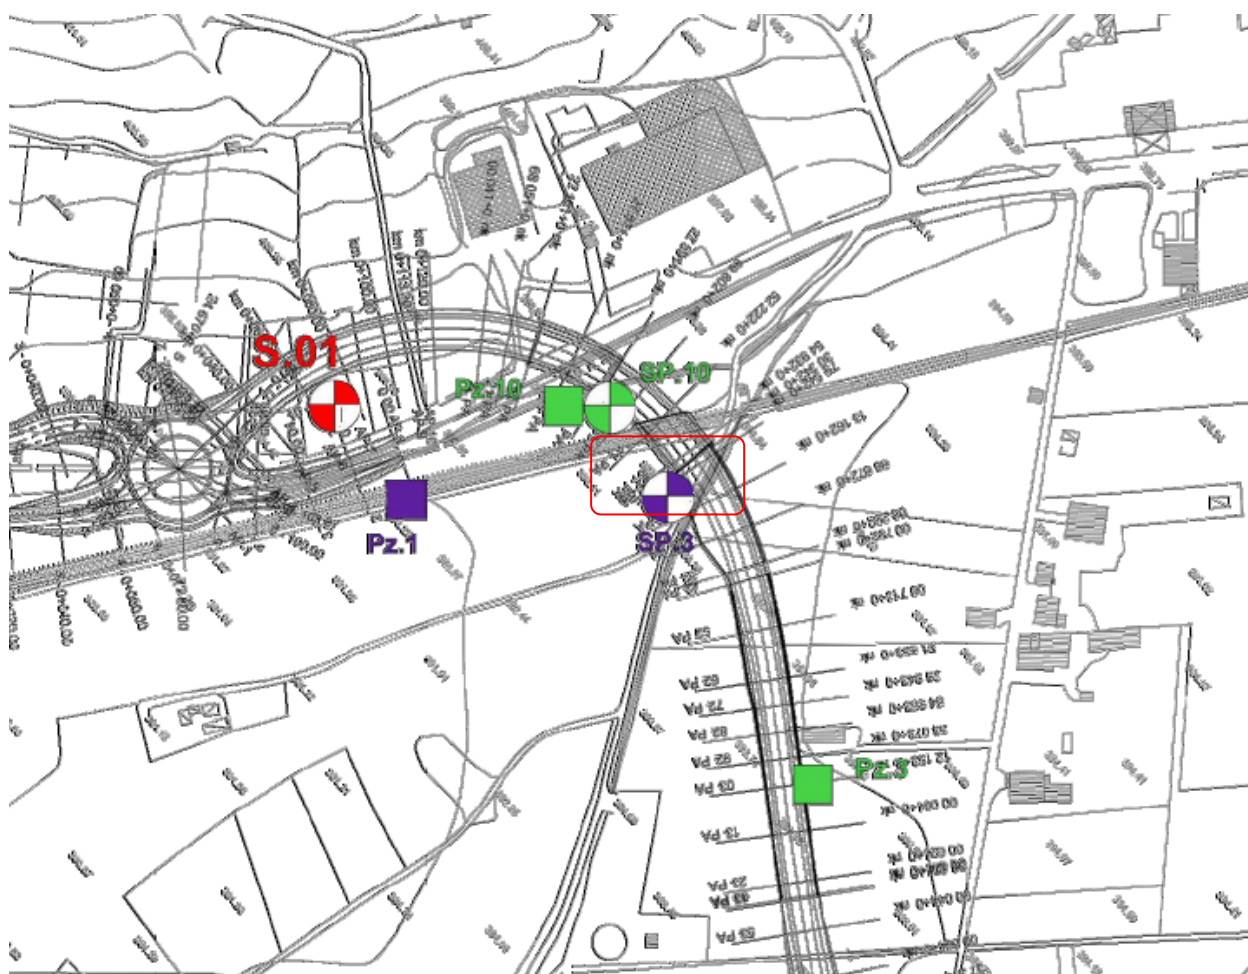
stralcio della planimetria con ubicazione dei sondaggi nel tratto di interesse
